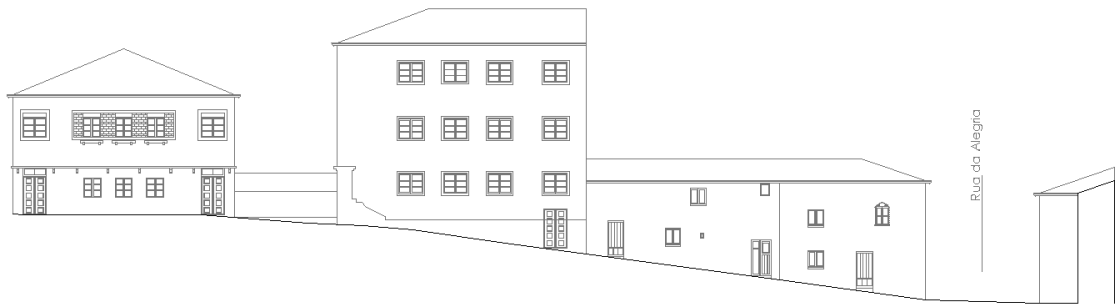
Levantamento parcial das fachadas Sul da Rua do Ginásio. Ver Anexo 10.
